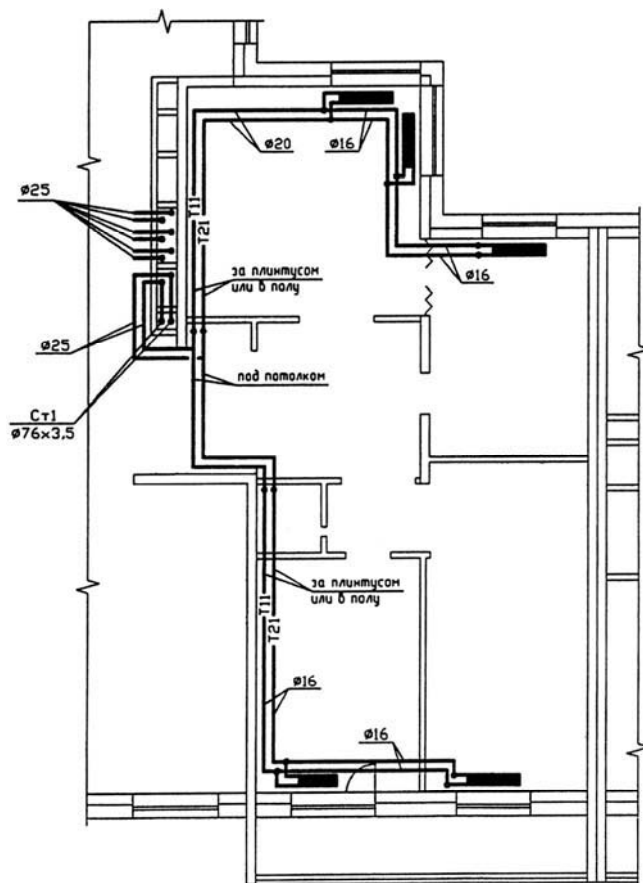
Система отопления с плинтусной разводкой теплопроводов по квартире
